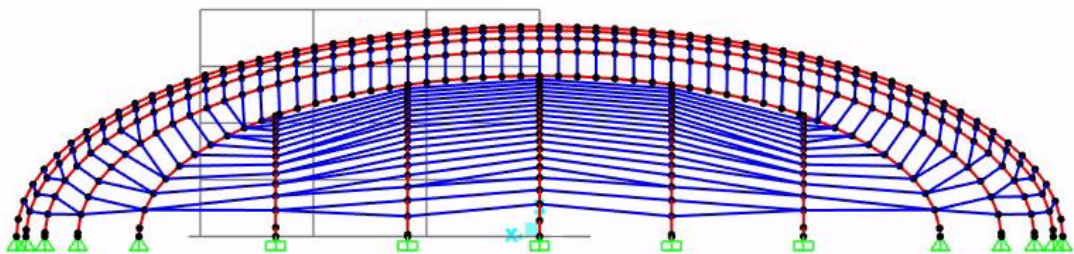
Vista dorsal del modelo estructural en SAP2000.
